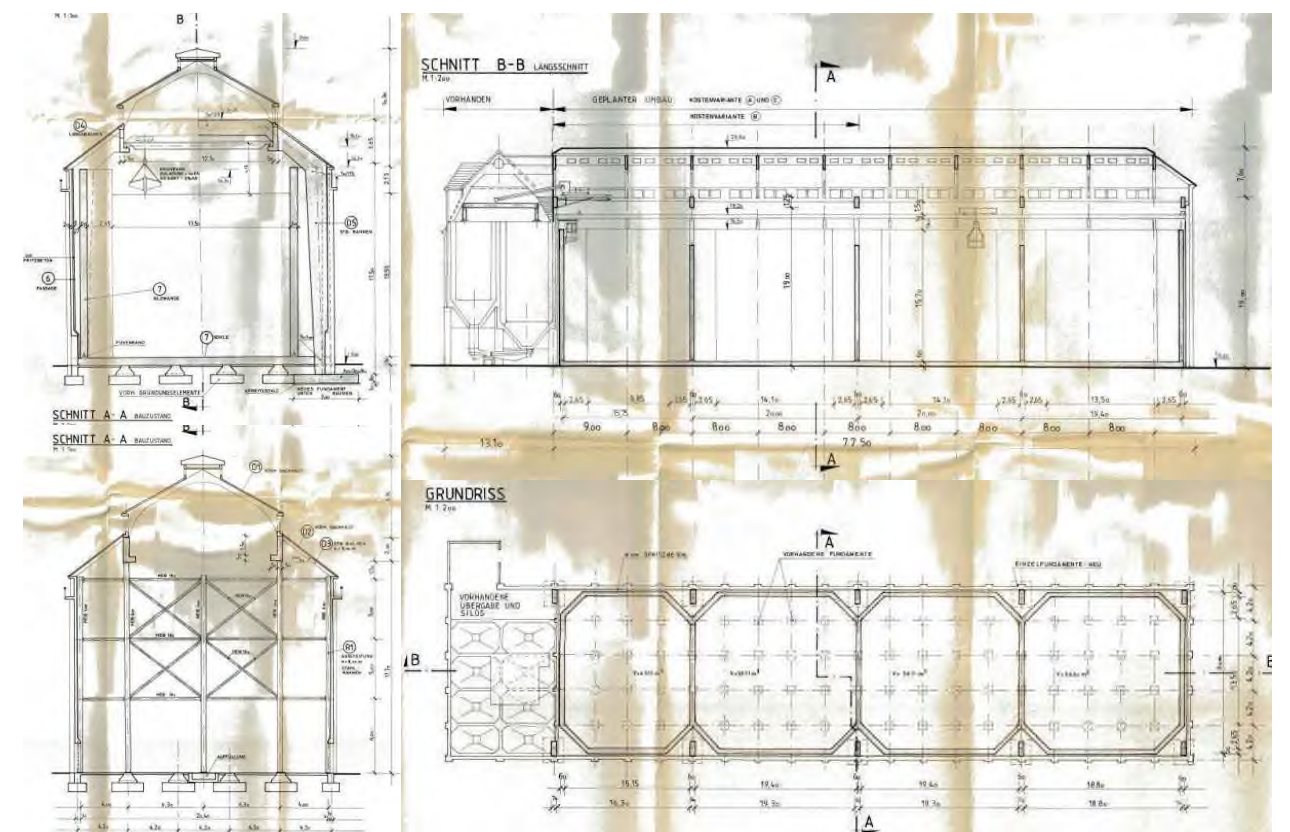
Kohlebunker Grundriss + Schnitte Bestand © Stadt Pforzheim
